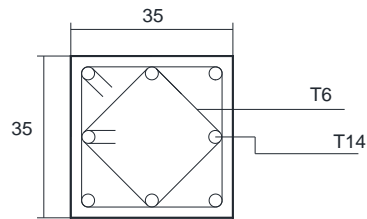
Ferrailage d'un poteau 35x35cm (poutres noyées – plancher au dalles pleines)
